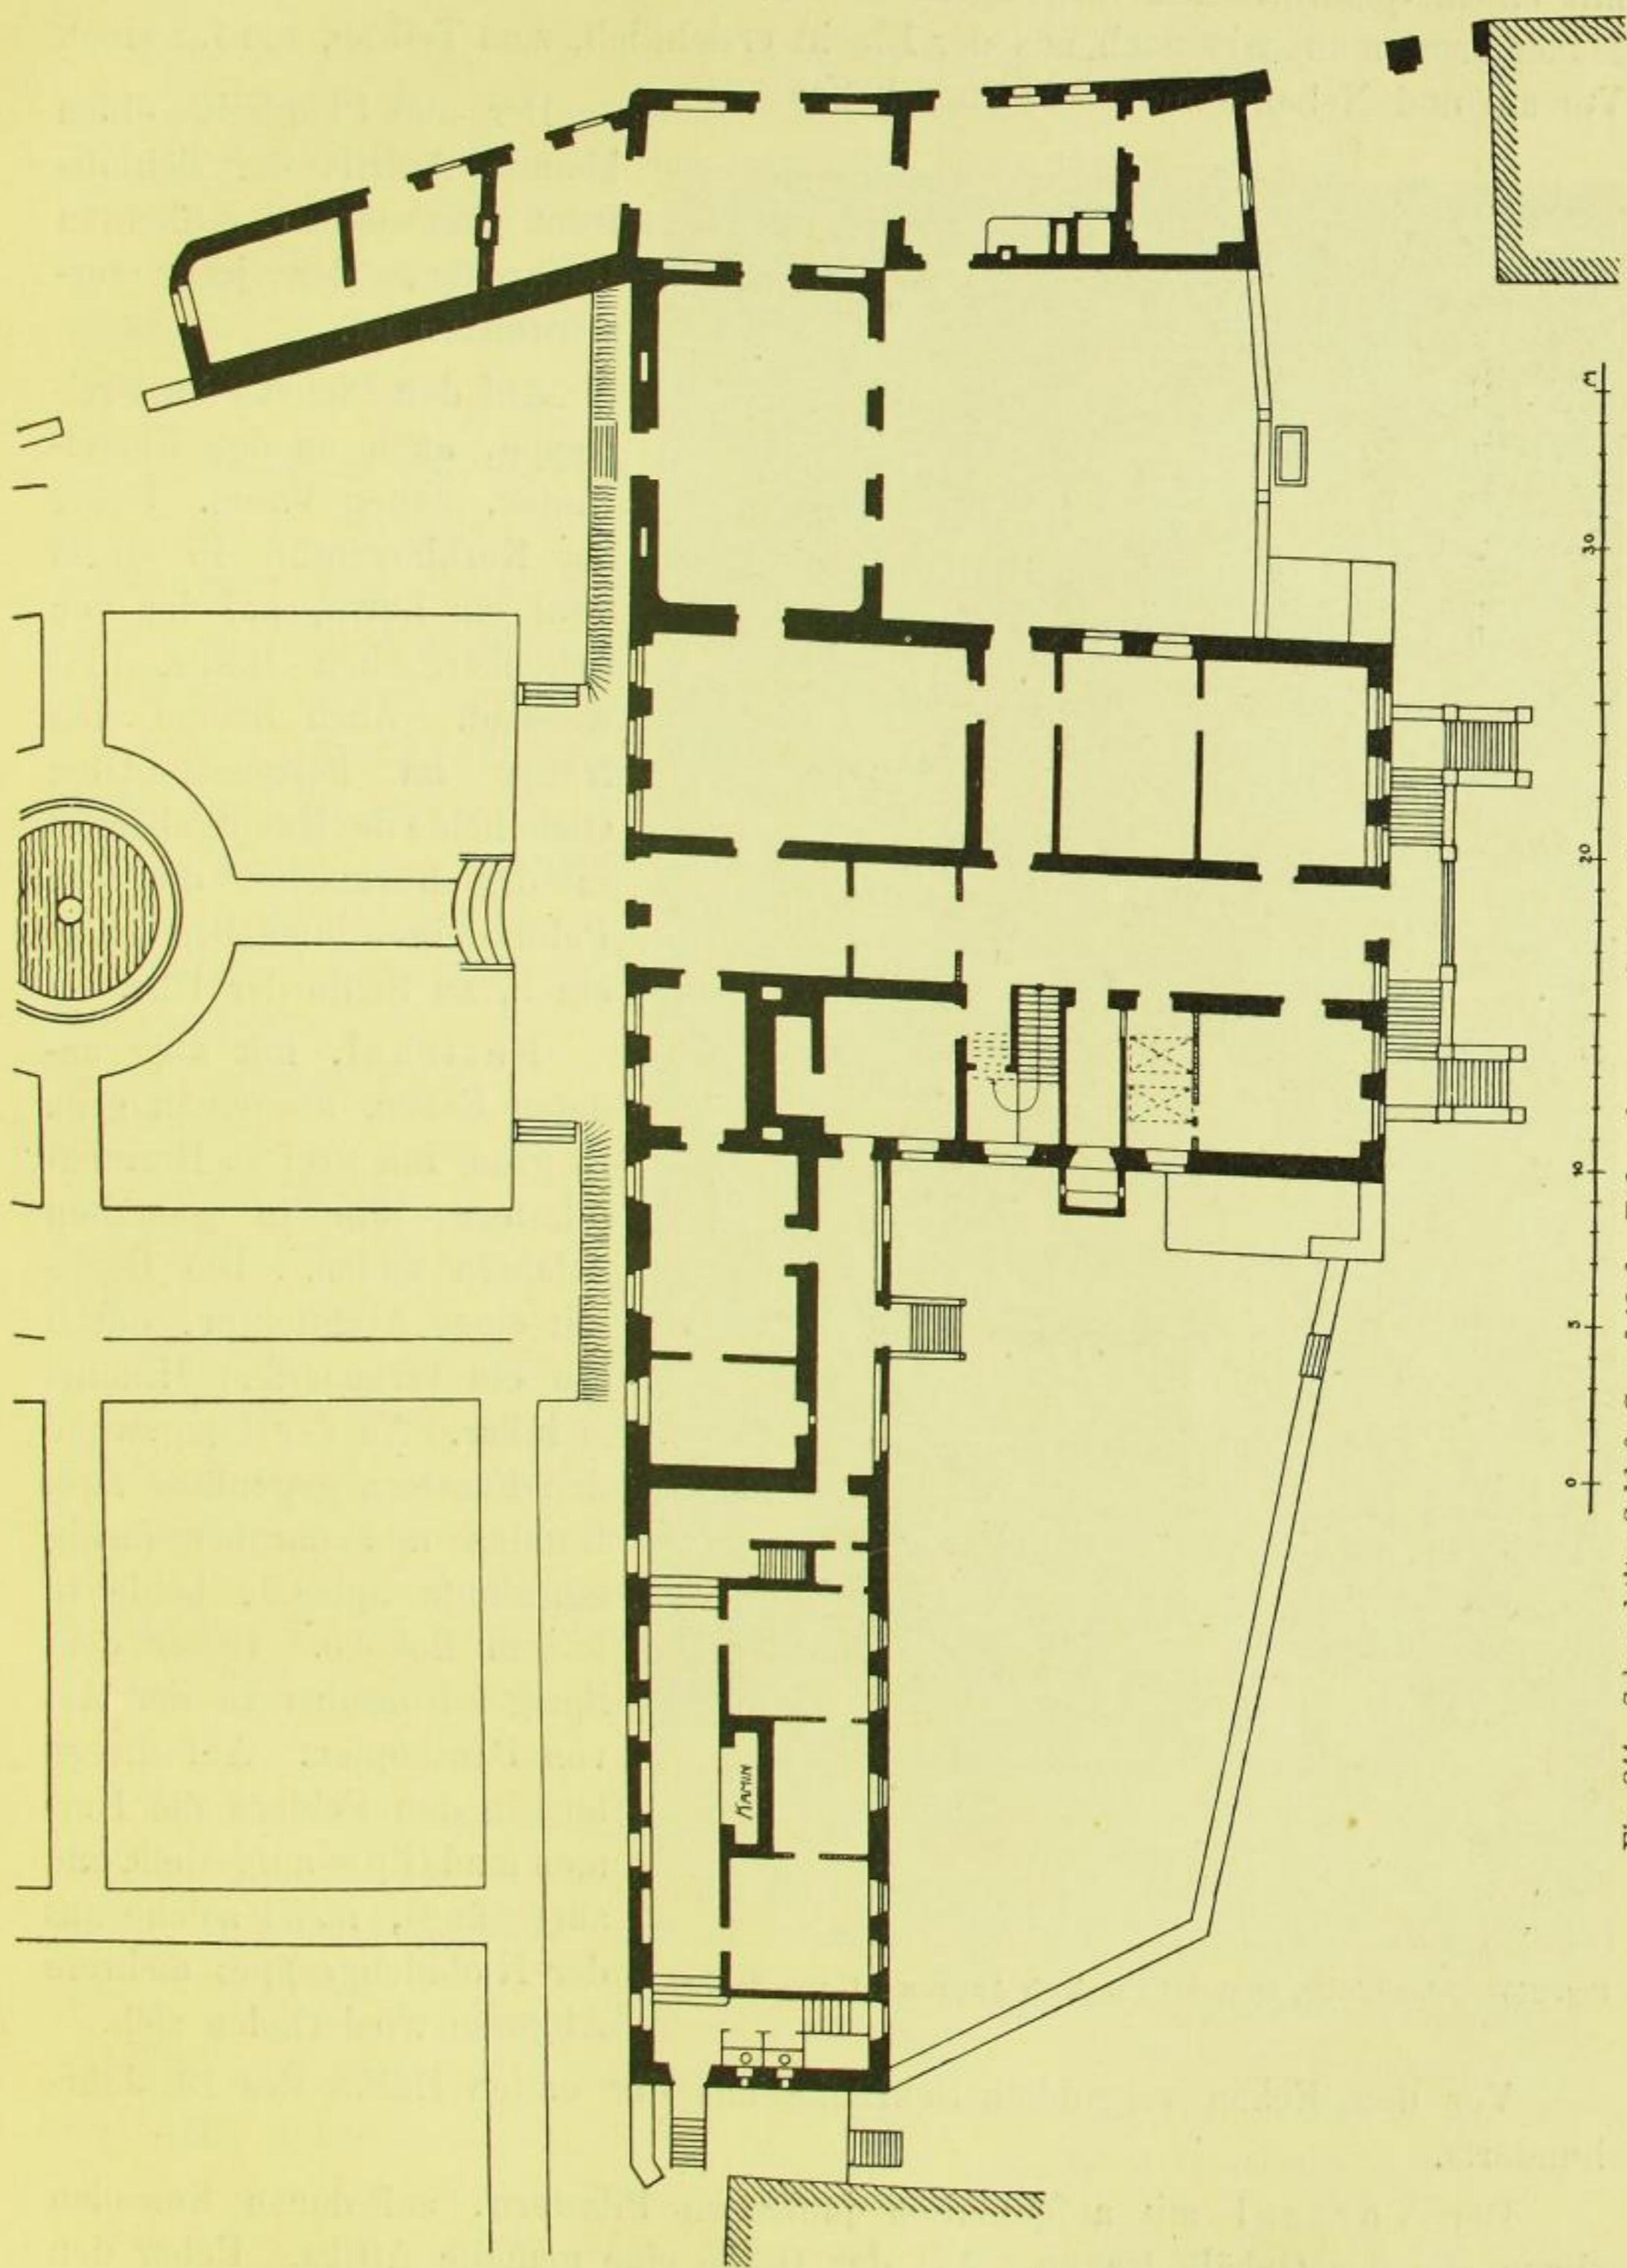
Schmochtitz, Schloß, Grundriß des Erdgeschosses nach dem Pöppelmannschen Plan von 1764.
